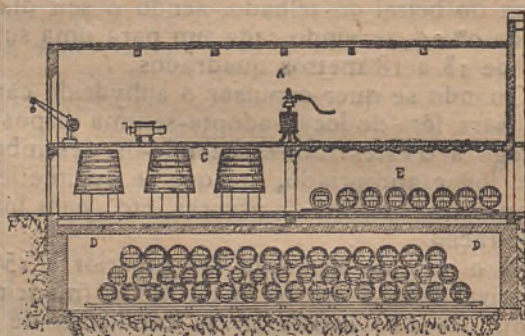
PAVIMENTOS DE UMA ADEGA
